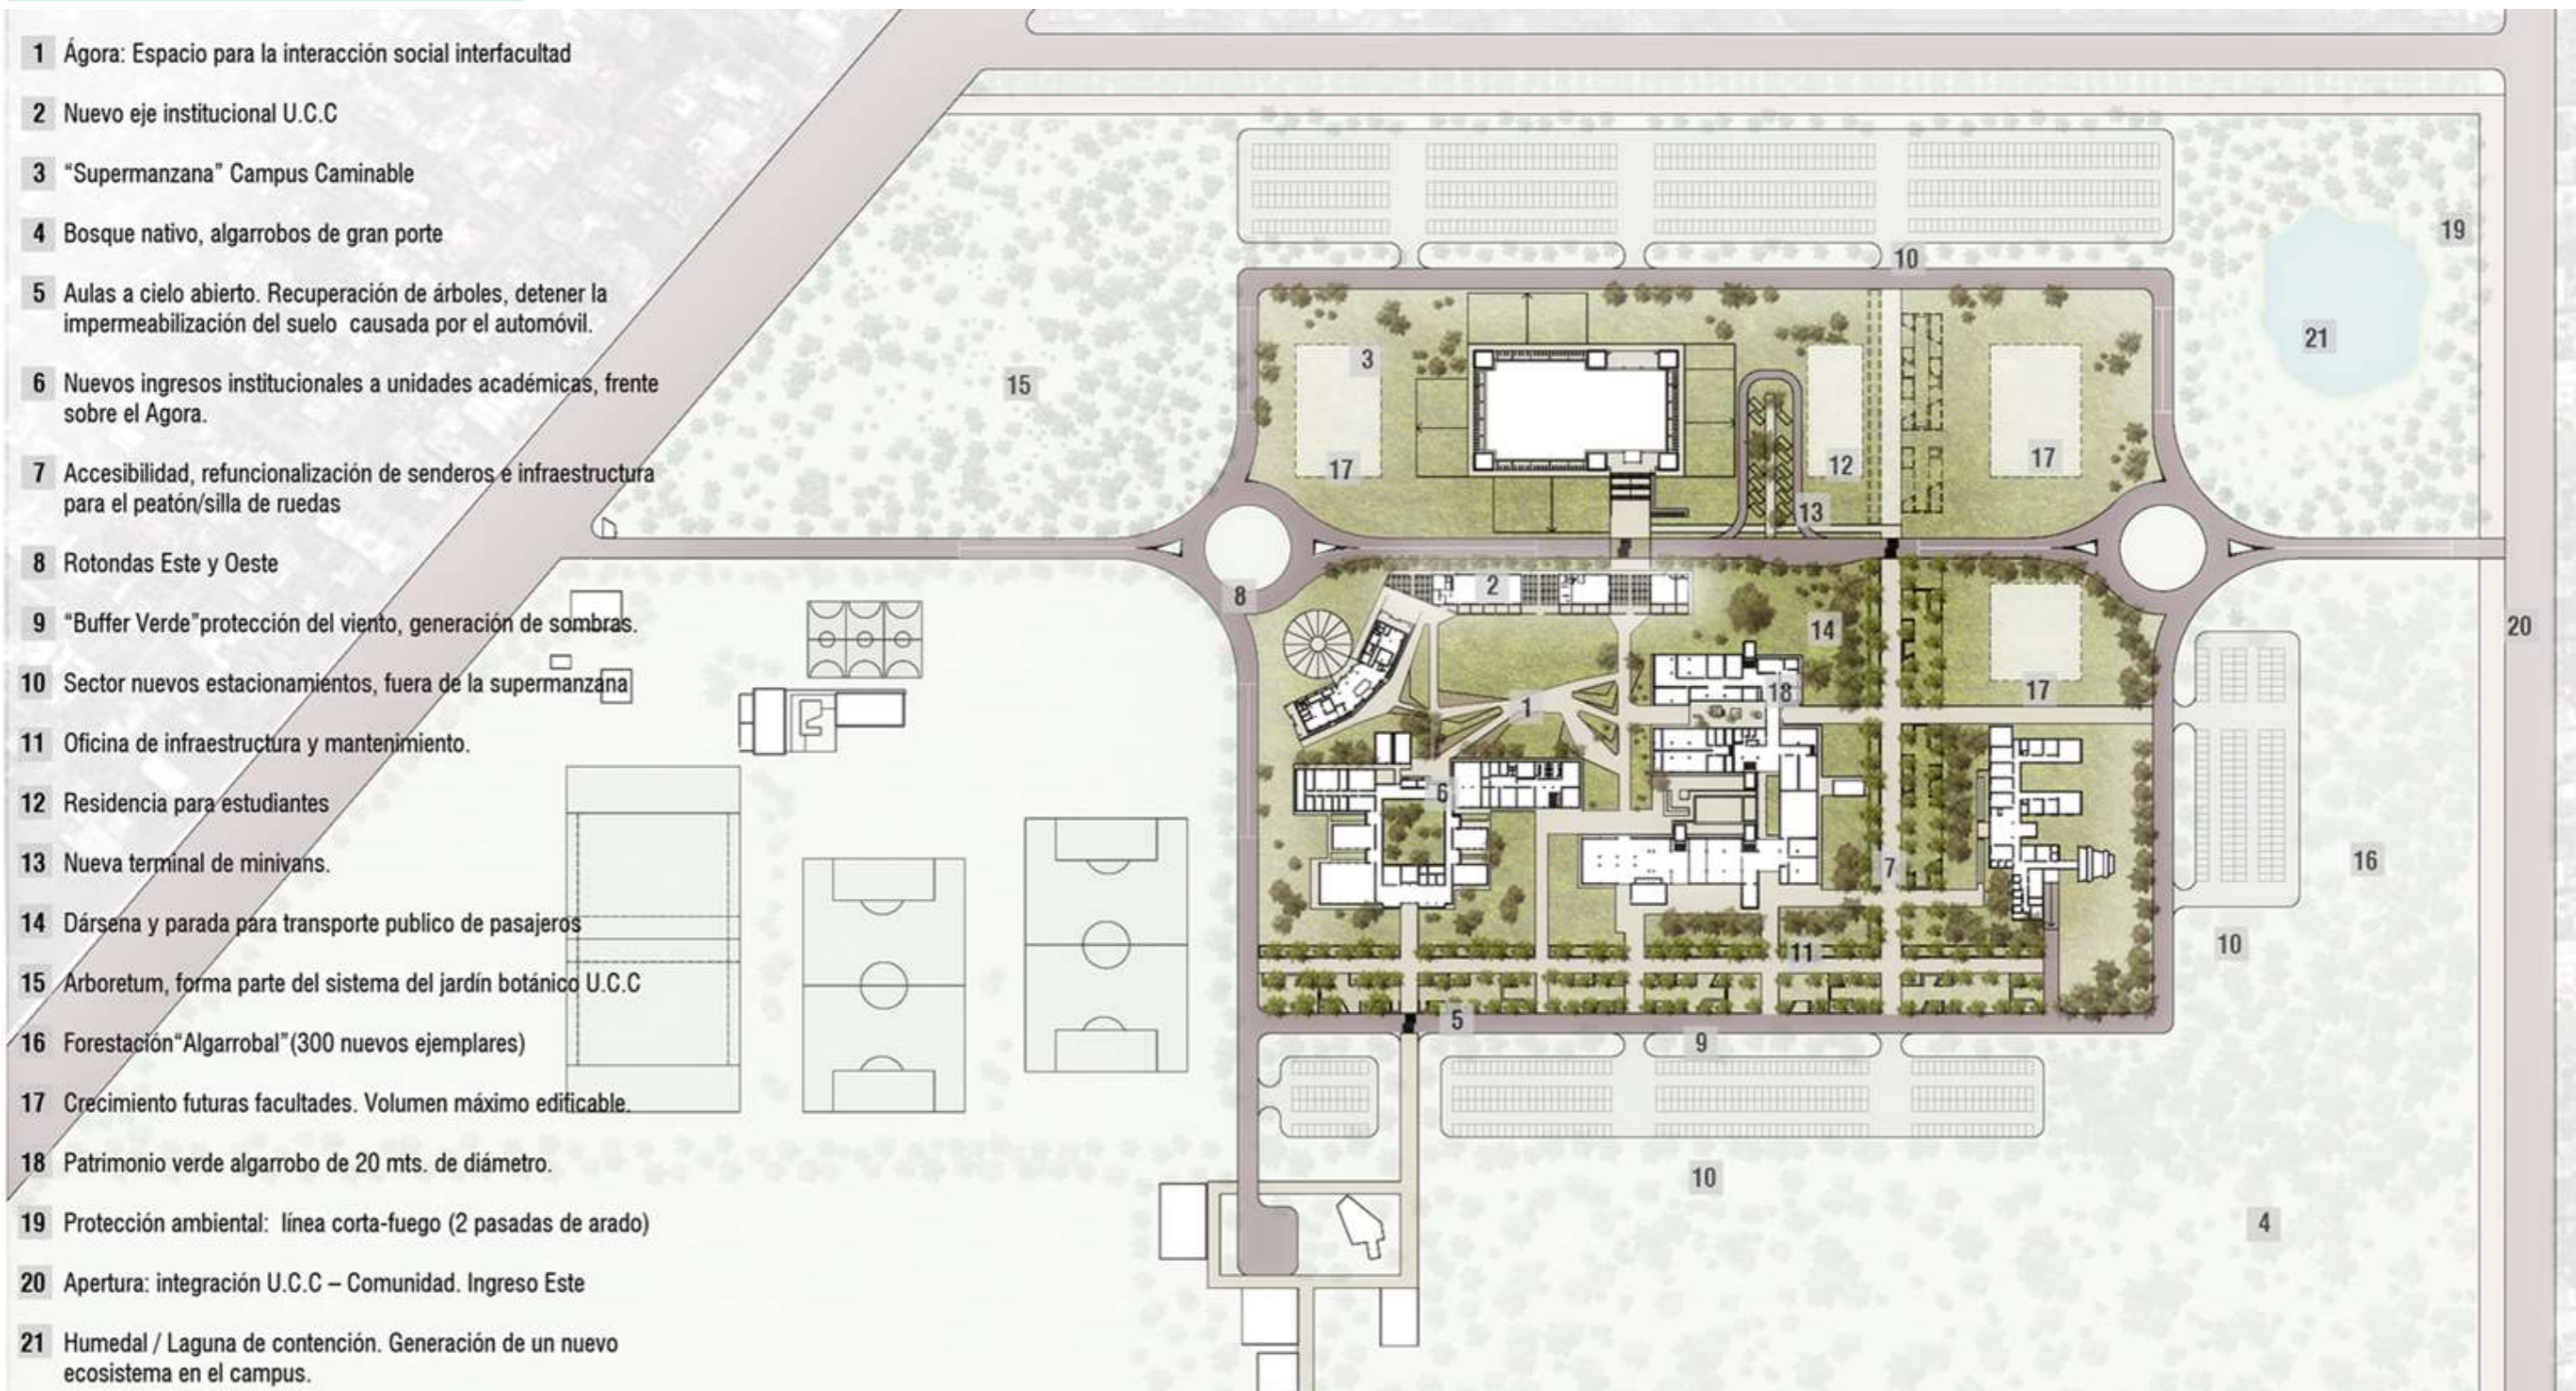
Planimetría del anteproyecto. Fuente: Plataforma ARQ
